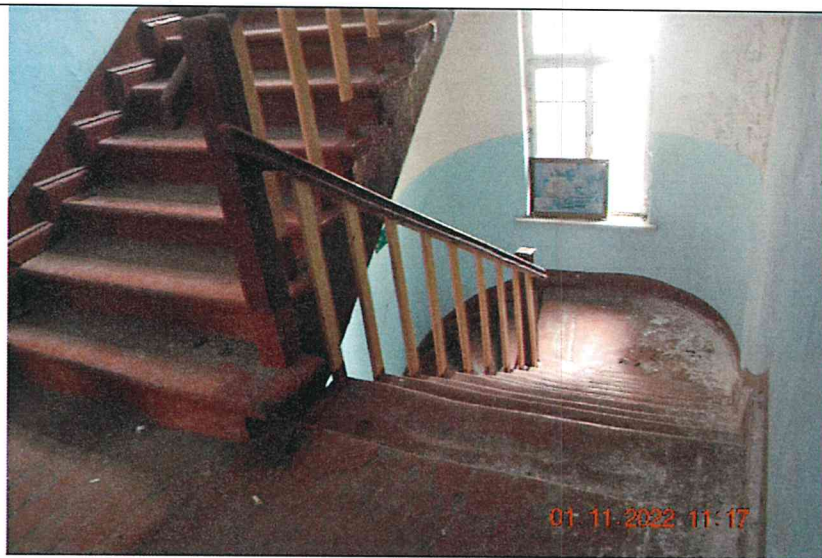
Главная лестница. Вид с площадки третьего этажа.
